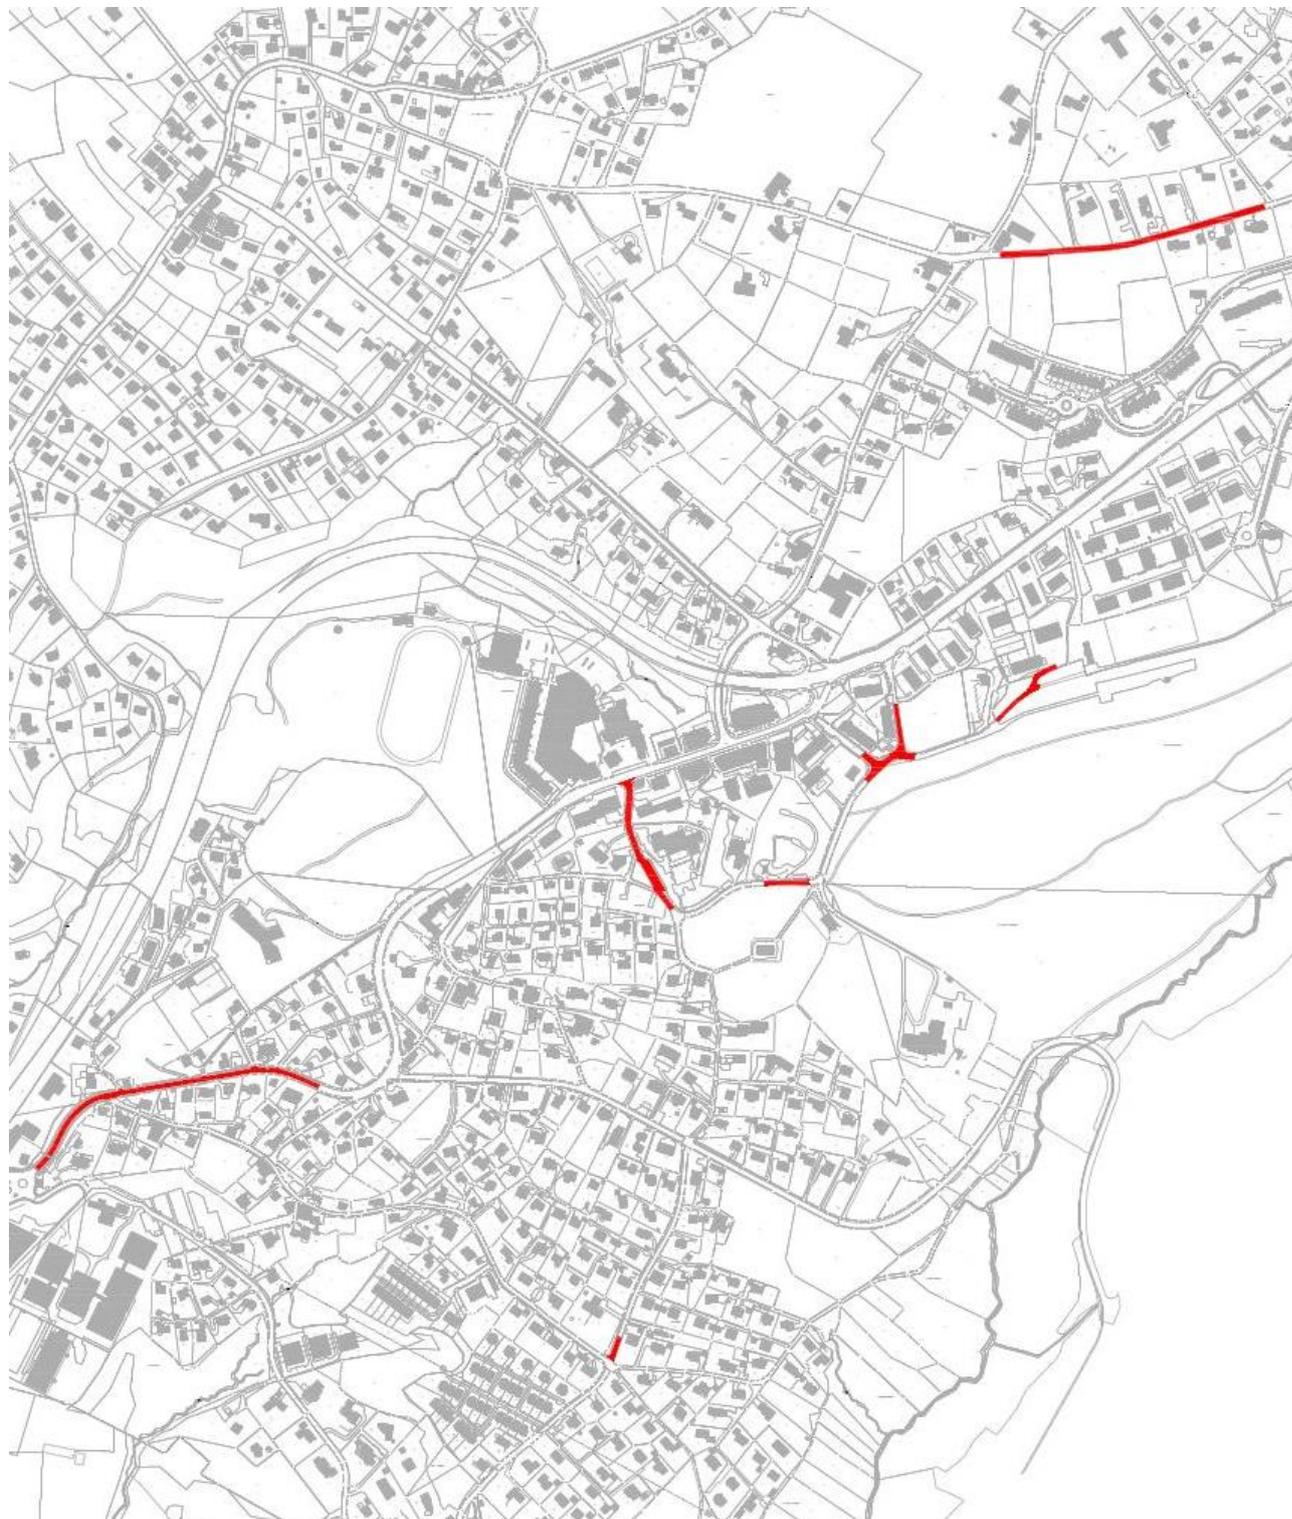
Plan de situation avec l'ensemble des travaux projetés
